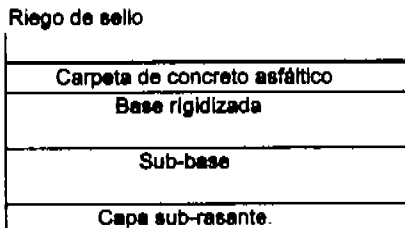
Capas que forman un pavimento flexible con carpeta de concreto asfáltico.
